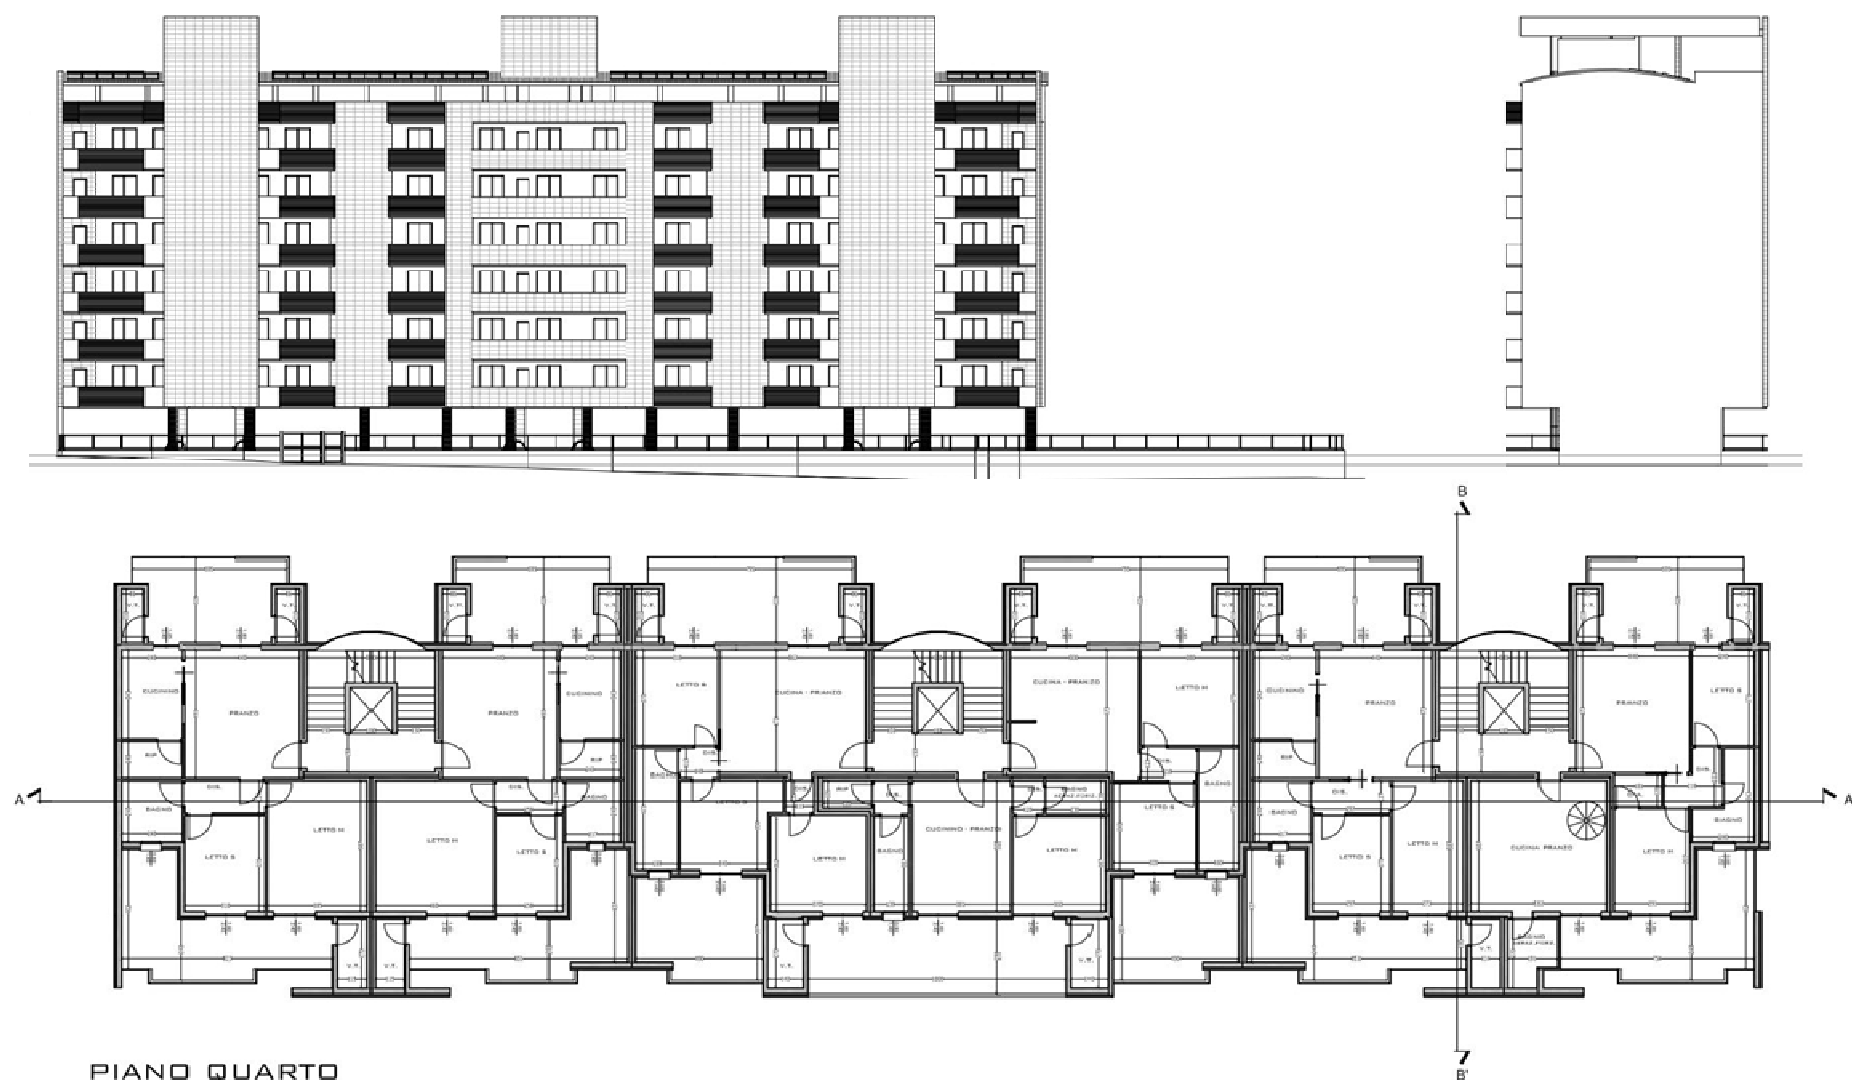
Blocco A3 – Prospetto anteriore, prospetto laterale sinistro e pianta piano tipo
